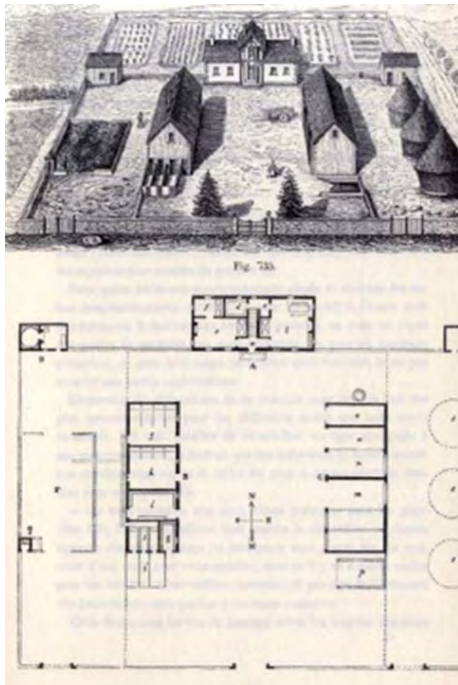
Ferme de la Corbellière, Menil-Erreux Extrait du traité de constructions rurales de Bouchard-Huzard, 1842
